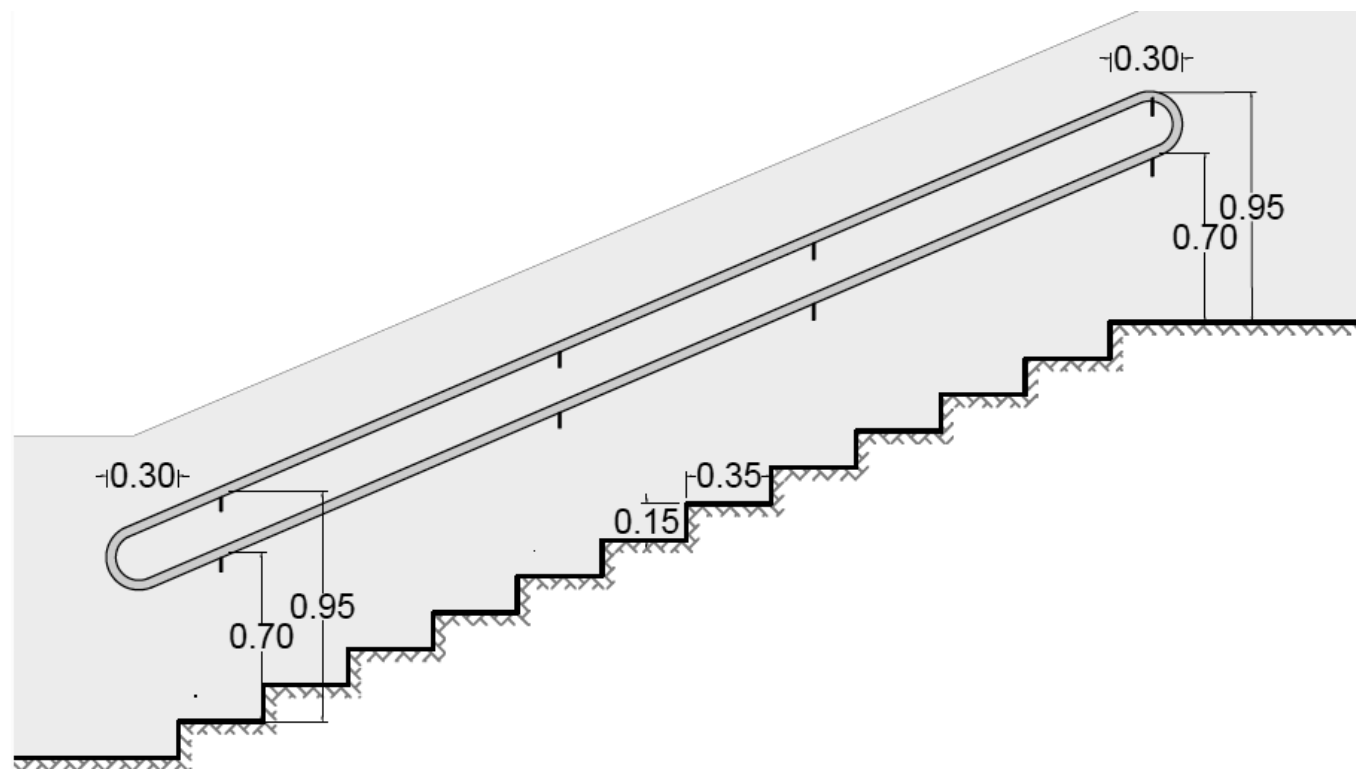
Passamà doble de inox amb estructura anclada a paret.
